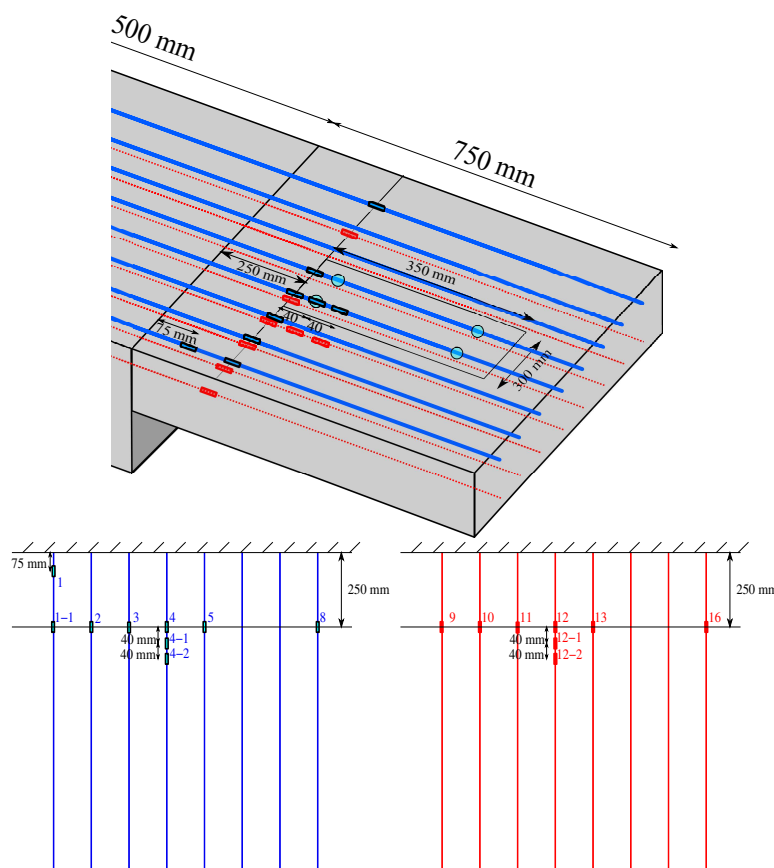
Position des jauges de déformation sur les armatures de la dalle de référence et la dalle 2
